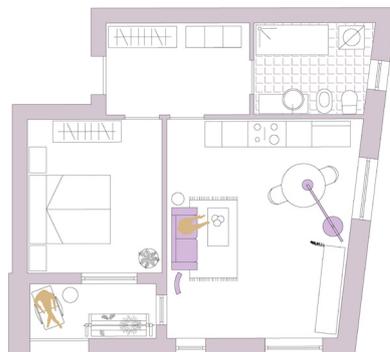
Rappresentazione planimetrica appartamento Urban Housing con arredi.
